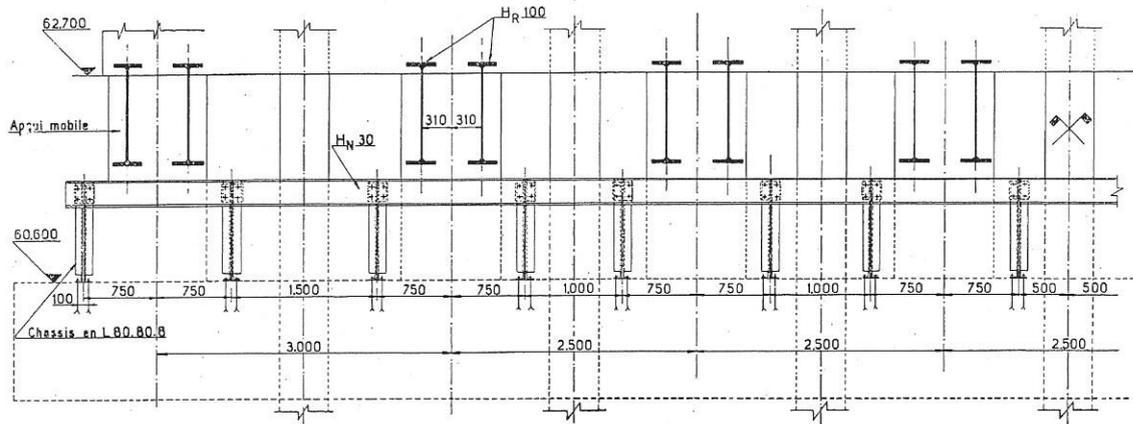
Coupe longitudinale partielle à la pile de rive droite.
